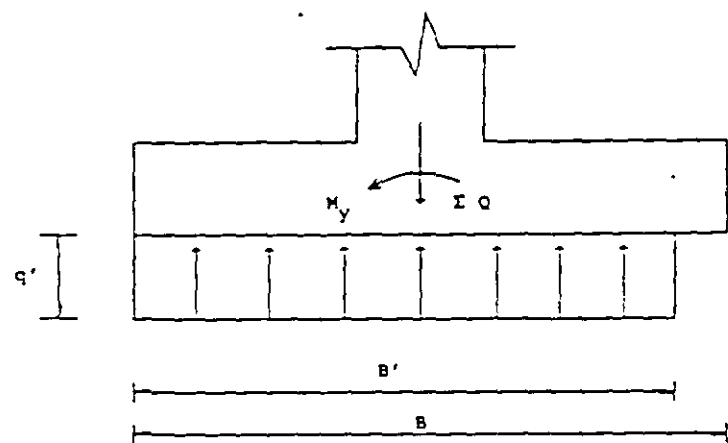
CARACTERISTICAS ESTRUCTURALES DE LA ZAPATA (EJEMPLO 5.4)
